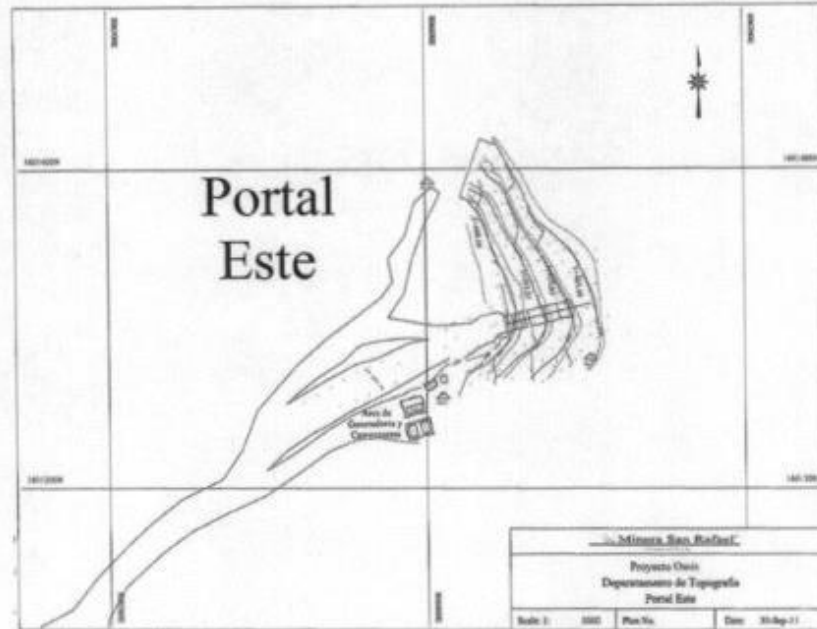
Plano de ubicación y área de construcción del portal Este.
